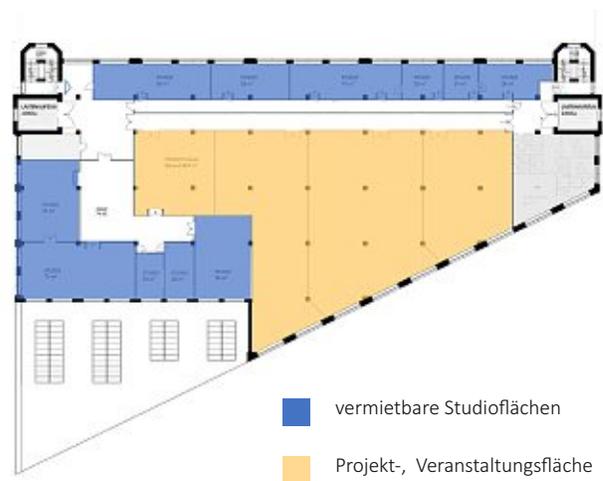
Grundriss Traktorfabrik Nutzungsverteilung
